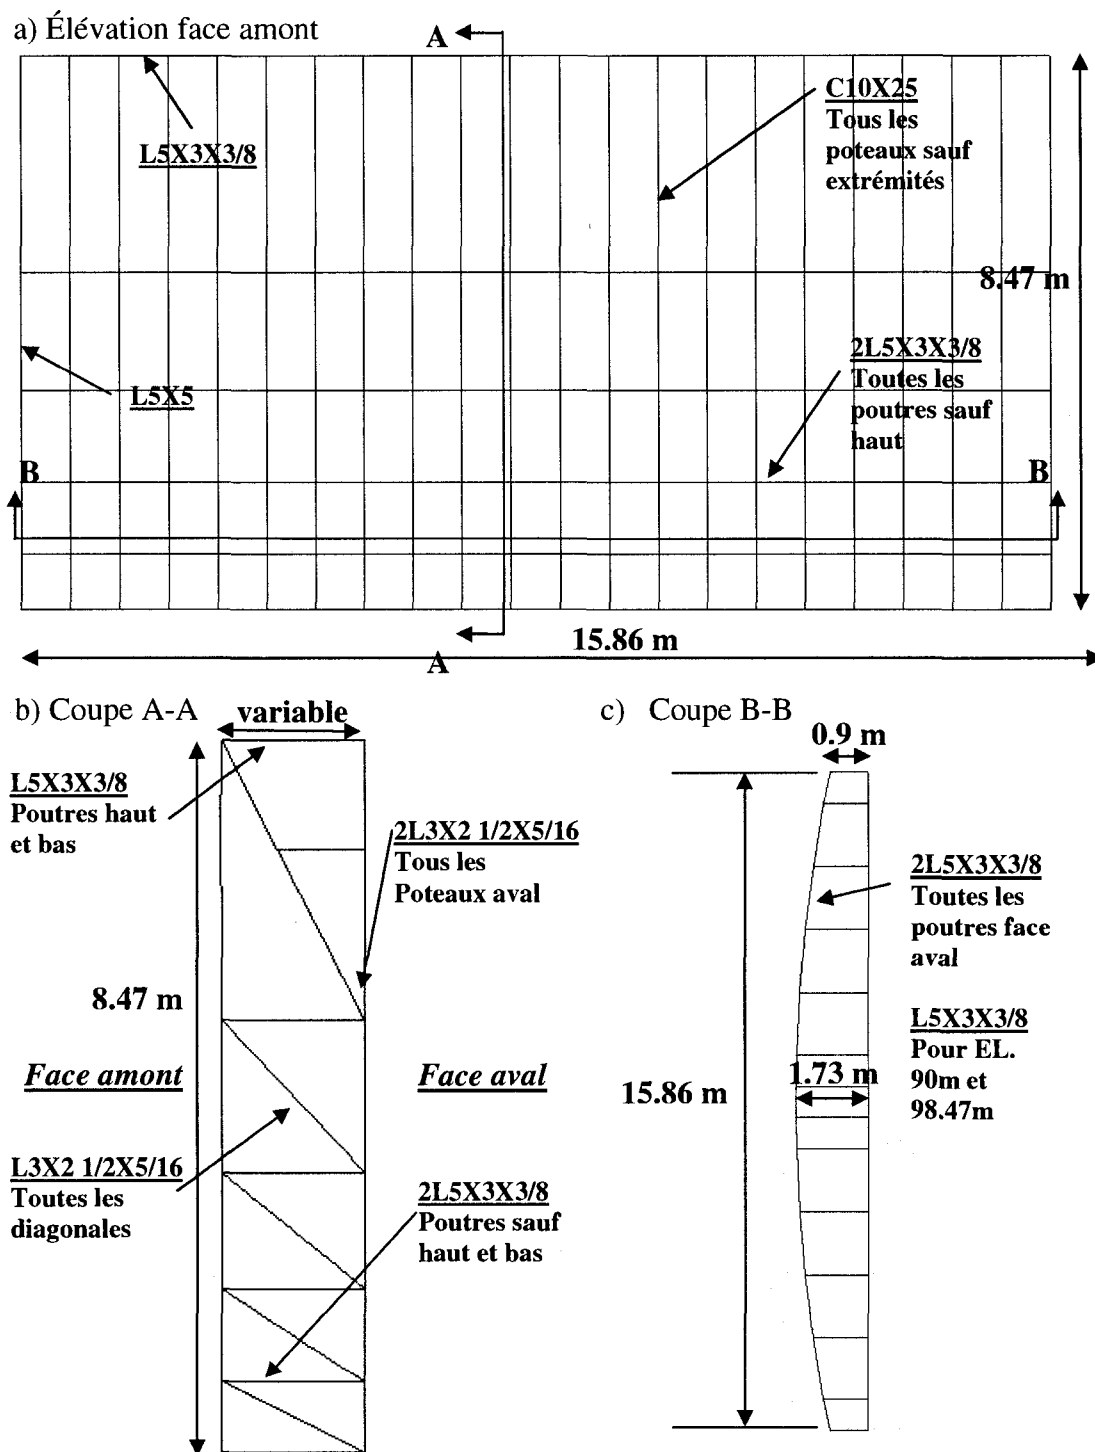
Vanne selon les plans initiaux : a) vue en élévation de la face aval; b) coupe A-A; c) coupe B-B
